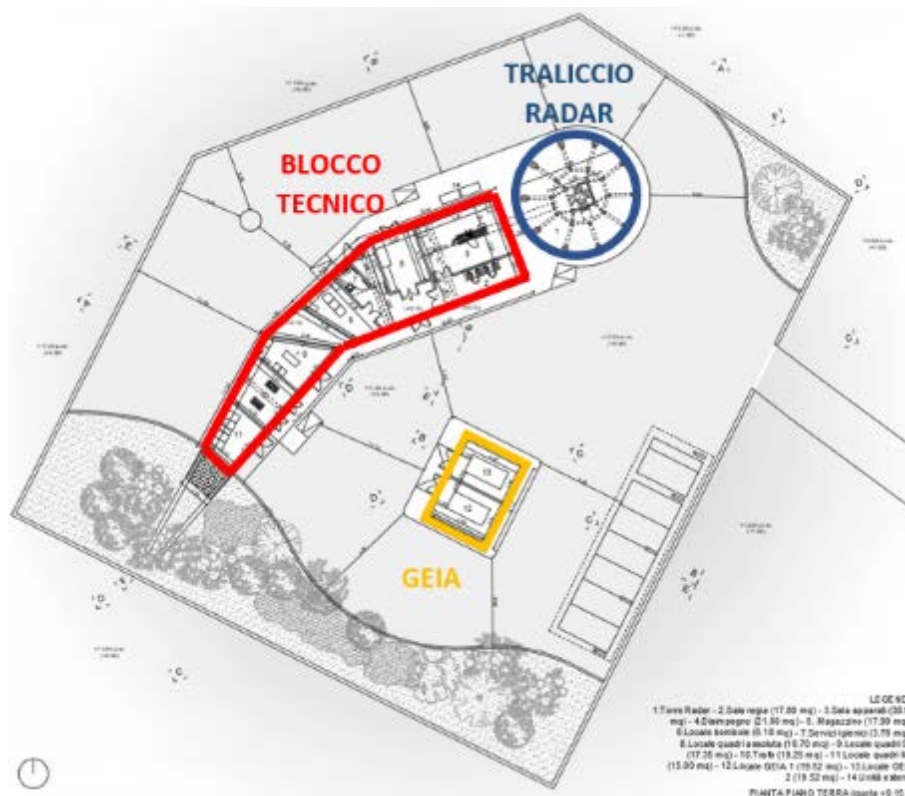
Stralcio pianta pianoterra con individuazione delle funzioni.
